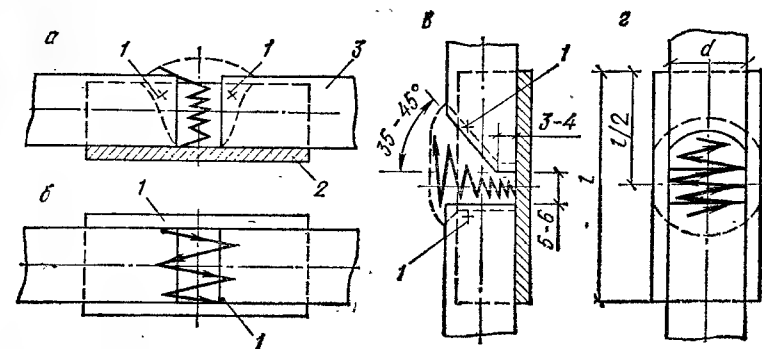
Рекомендуемая последовательность сварки стыков стержней со скобами-подкладками
